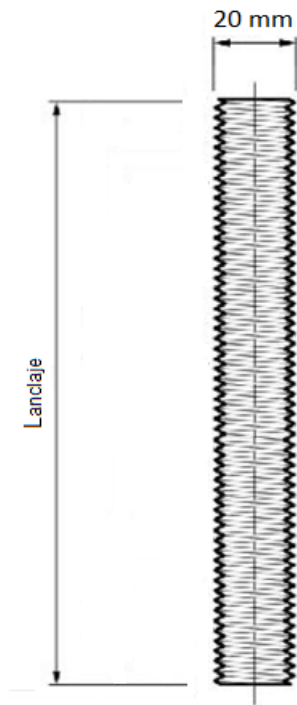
Detalle de las barras Dywidag (Ref. [2])
